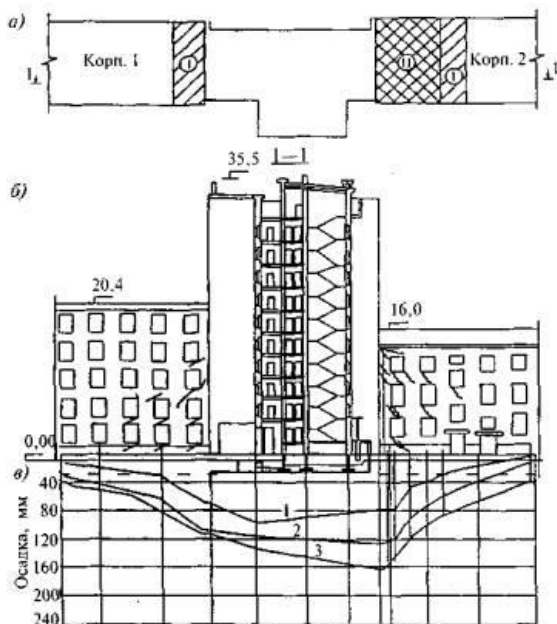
Схема осадки и деформации примыкающих частей зданий и встроенного объекта за период эксплуатации 10 лет: а - схема размещения встроенного здания; б - разрез по 1 - 1; в - графики осадки фундаментов для различных периодов наблюдения; 1 - кривая осадки фундаментов после возведения встройки; 2,3 - через 5 и 10 лет; I - часть зданий, получивших сильные повреждения; II - аварийные повреждения.
